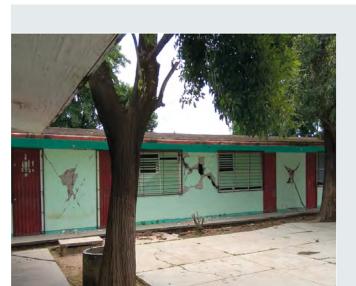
Agrietamiento por cortante en uniones viga-columna en marcos de concreto con muros diafragma. Fuente: cortesía del INIFED (2019b).
